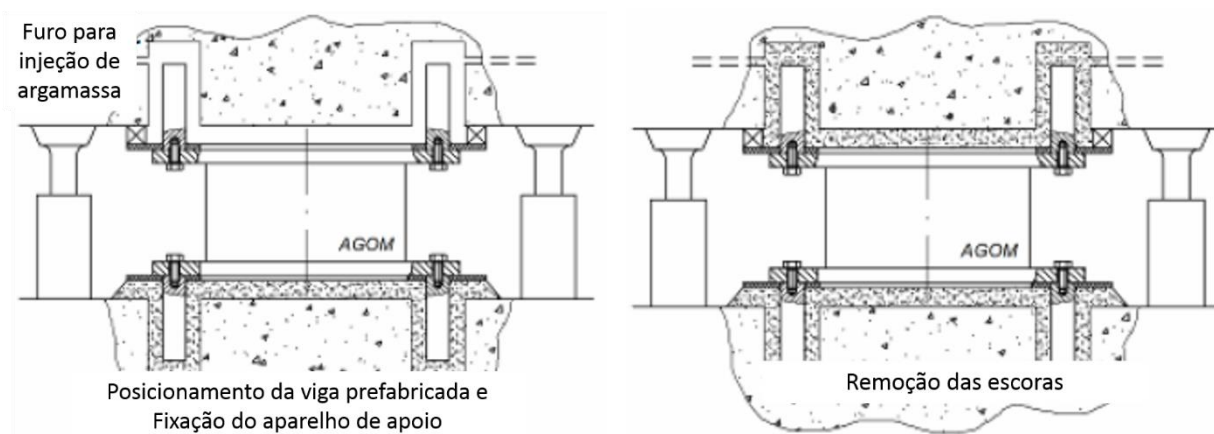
Instalação de aparelho de apoio numa viga prefabricada (fonte:(AGOM, 2013c))
